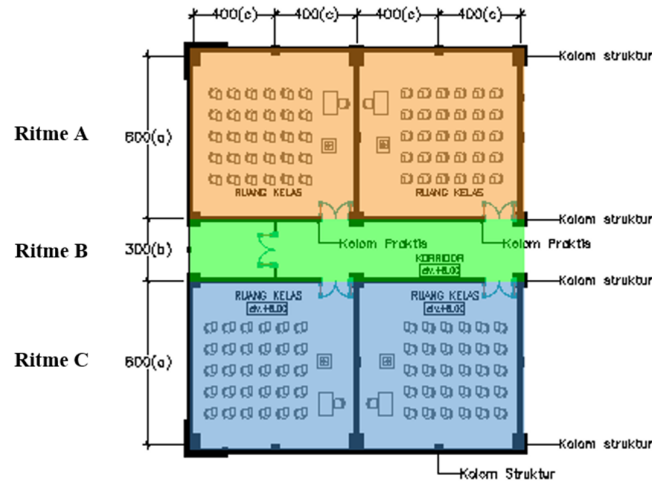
Gedung Telkom Palembang dengan keseimbangan struktur kolom, baik dari bentuk, ukuran dan jarak
